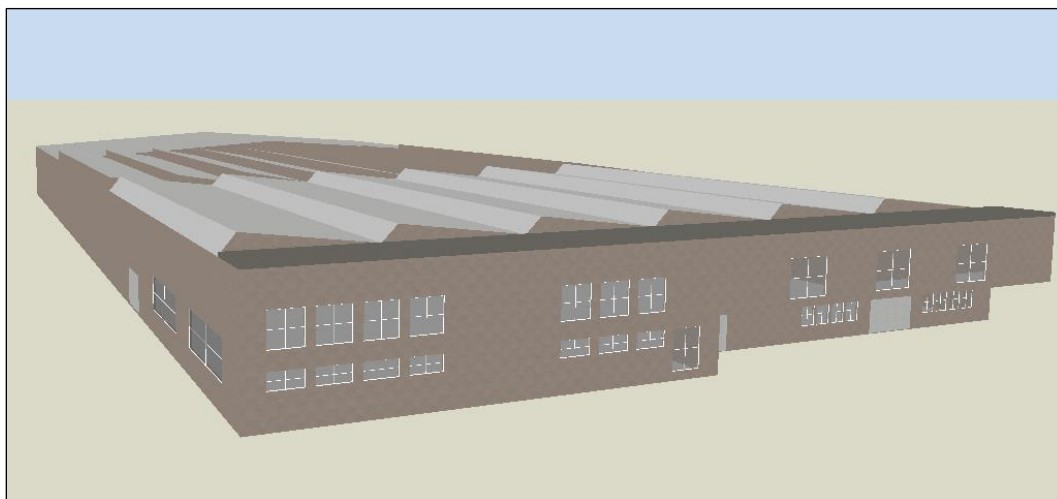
Perspetiva da fachada da empresa A modelada no DesignBuilder.
